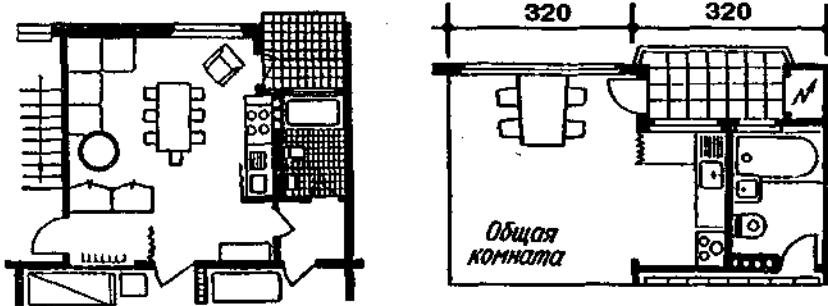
Планировки квартир с кухнями- нишами на газовых плитах
